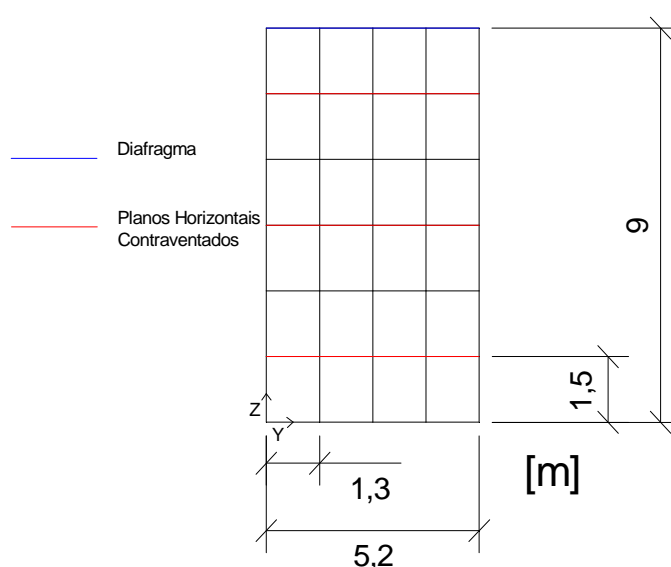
Exemplo de Planos Horizontais Contraventados de Forma Alternada, 3 m em 3 m
